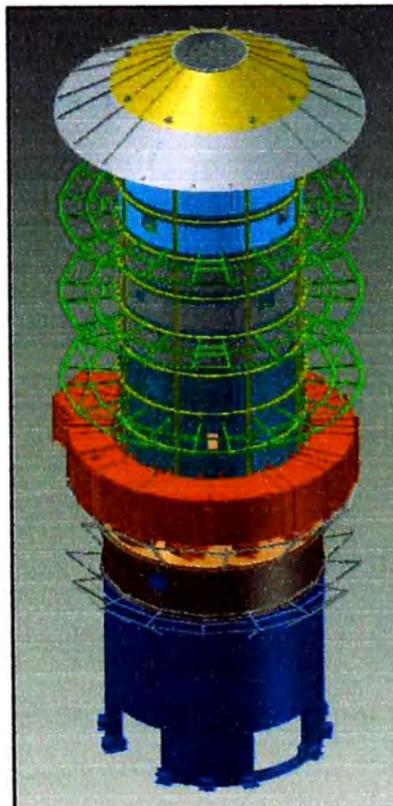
Conjunto Techo Cónico / Anillos 10@11 sobre la Torre
